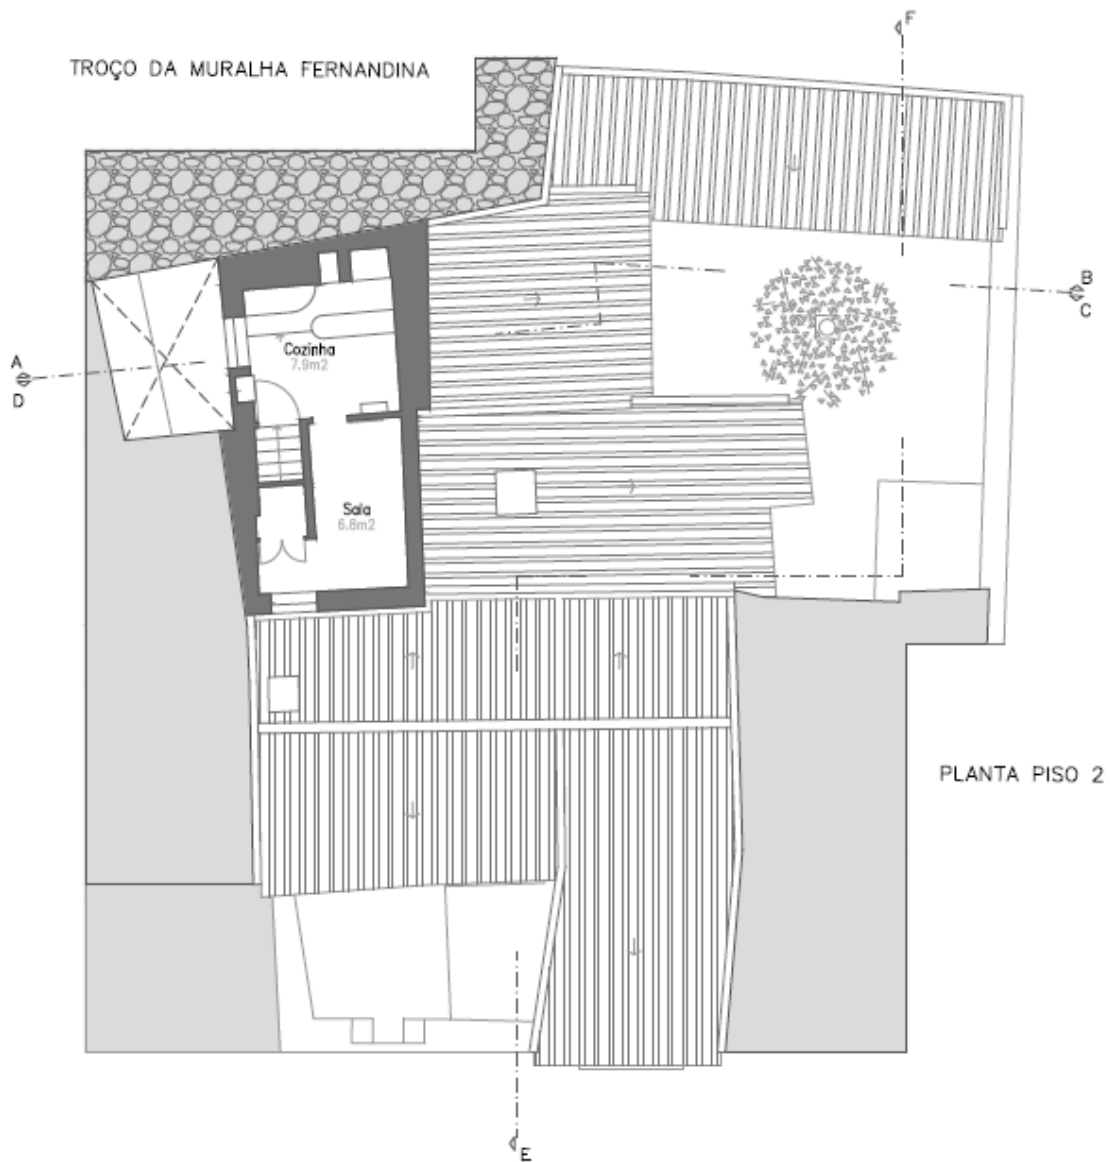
Planta Piso 02 existente (Sousa et al., 2021).
